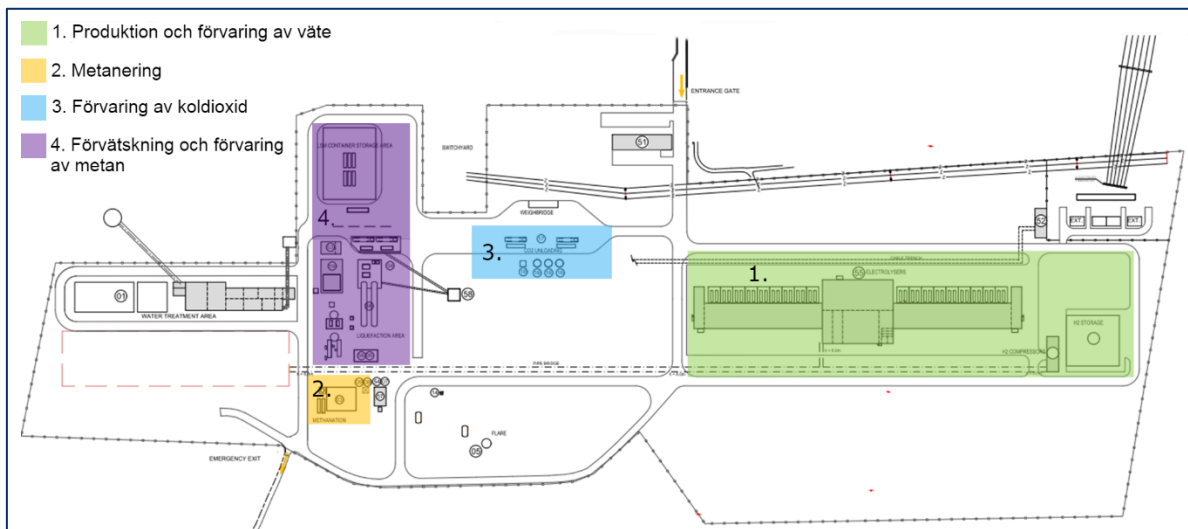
Planritning över placeringen av anläggningsenheter och -konstruktioner på anläggningsområdet, enligt alternativ ALT1.
